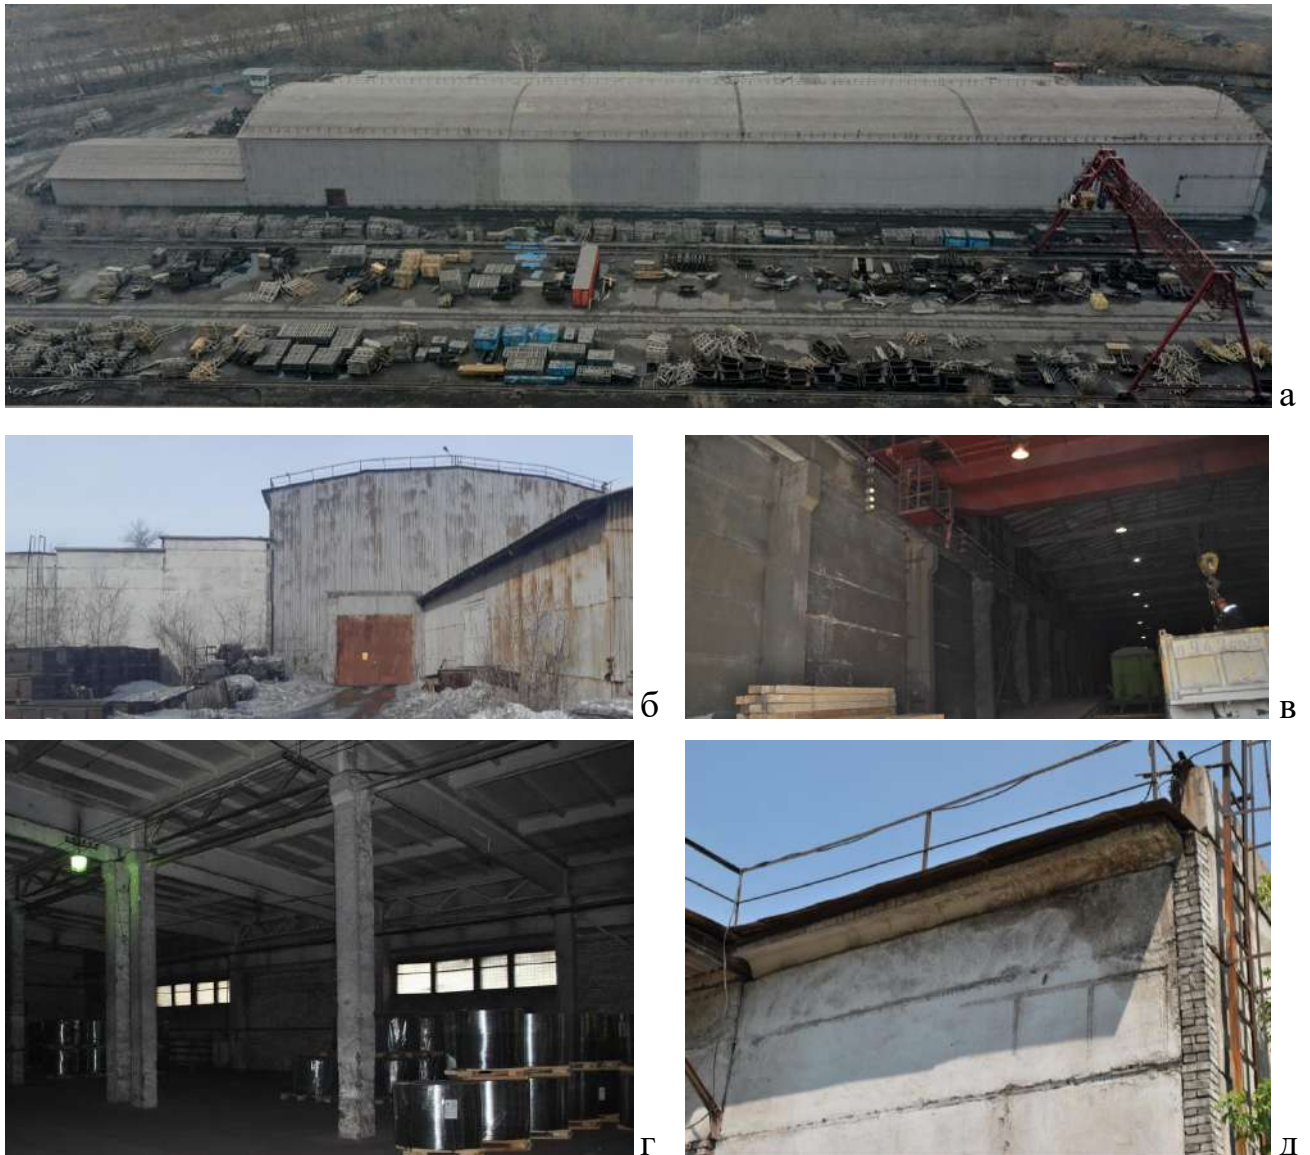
Вид здания склада № 54 управления подготовки производства ПАО «ММК»: а – общий вид здания; б – южный фасад здания; в, г – вид конструкций внутри здания; д – фрагмент фасада здания
